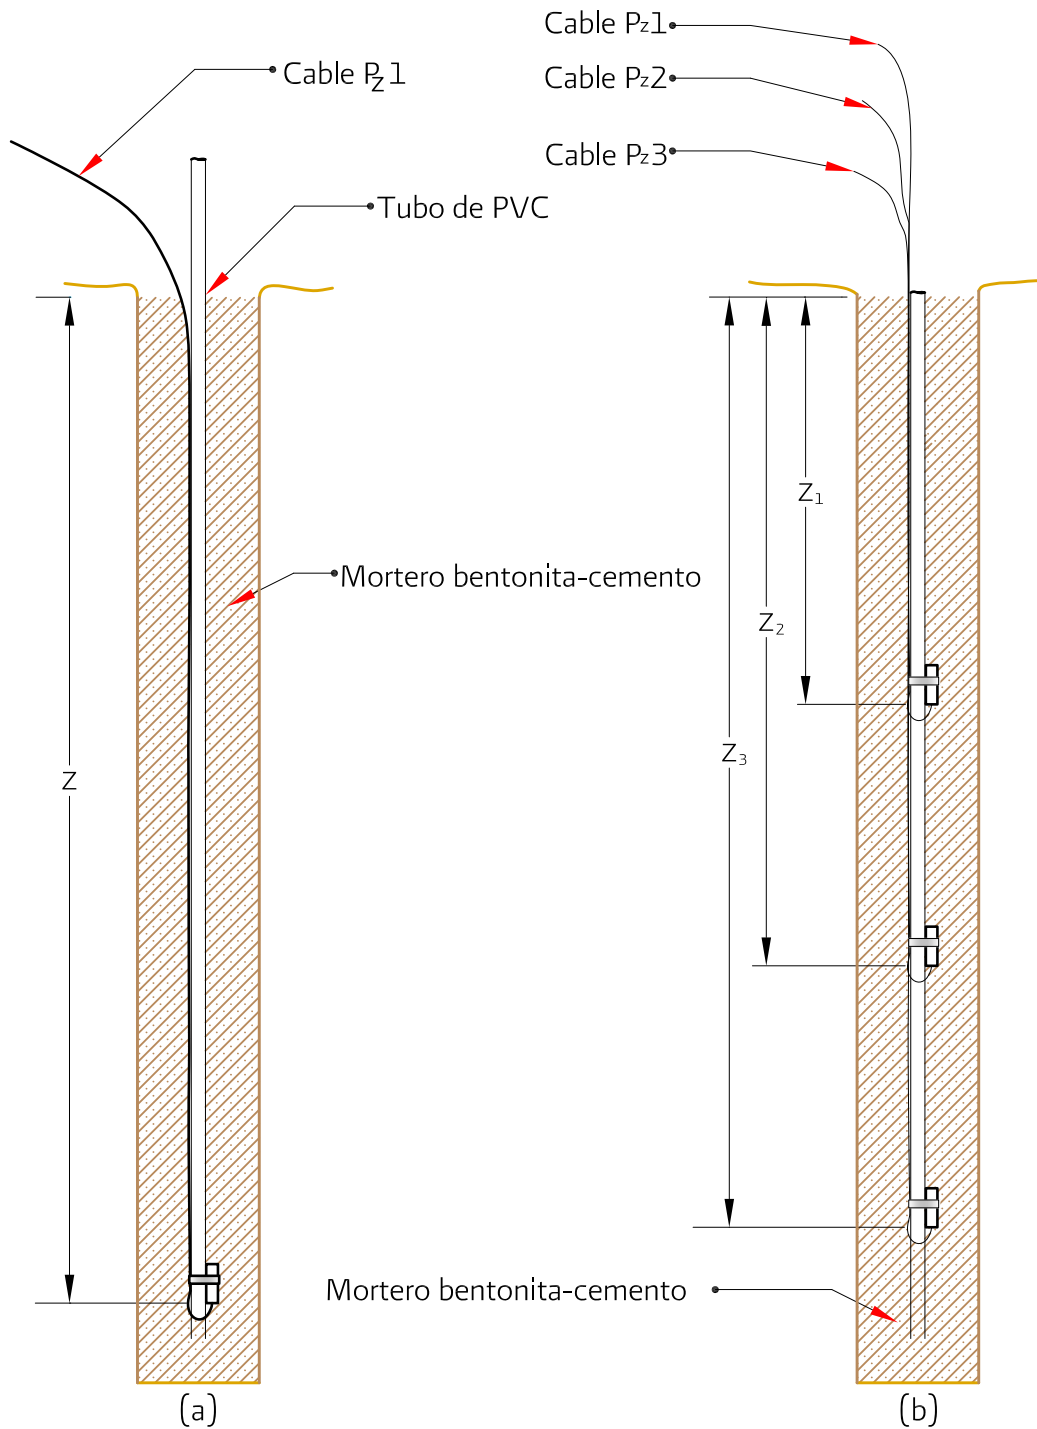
Piezómetros de cuerda vibrante soportados por una tubería de PVC de 1.91 cm ($\frac{3}{4}$ in) en barreno sellado con mortero cemento-bentonita:
